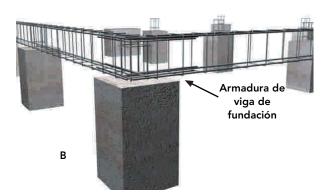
40: Vistas (A y B) de la unión entre la armadura del cimiento y la armadura de la viga de fundación y refuerzo de esquina.
